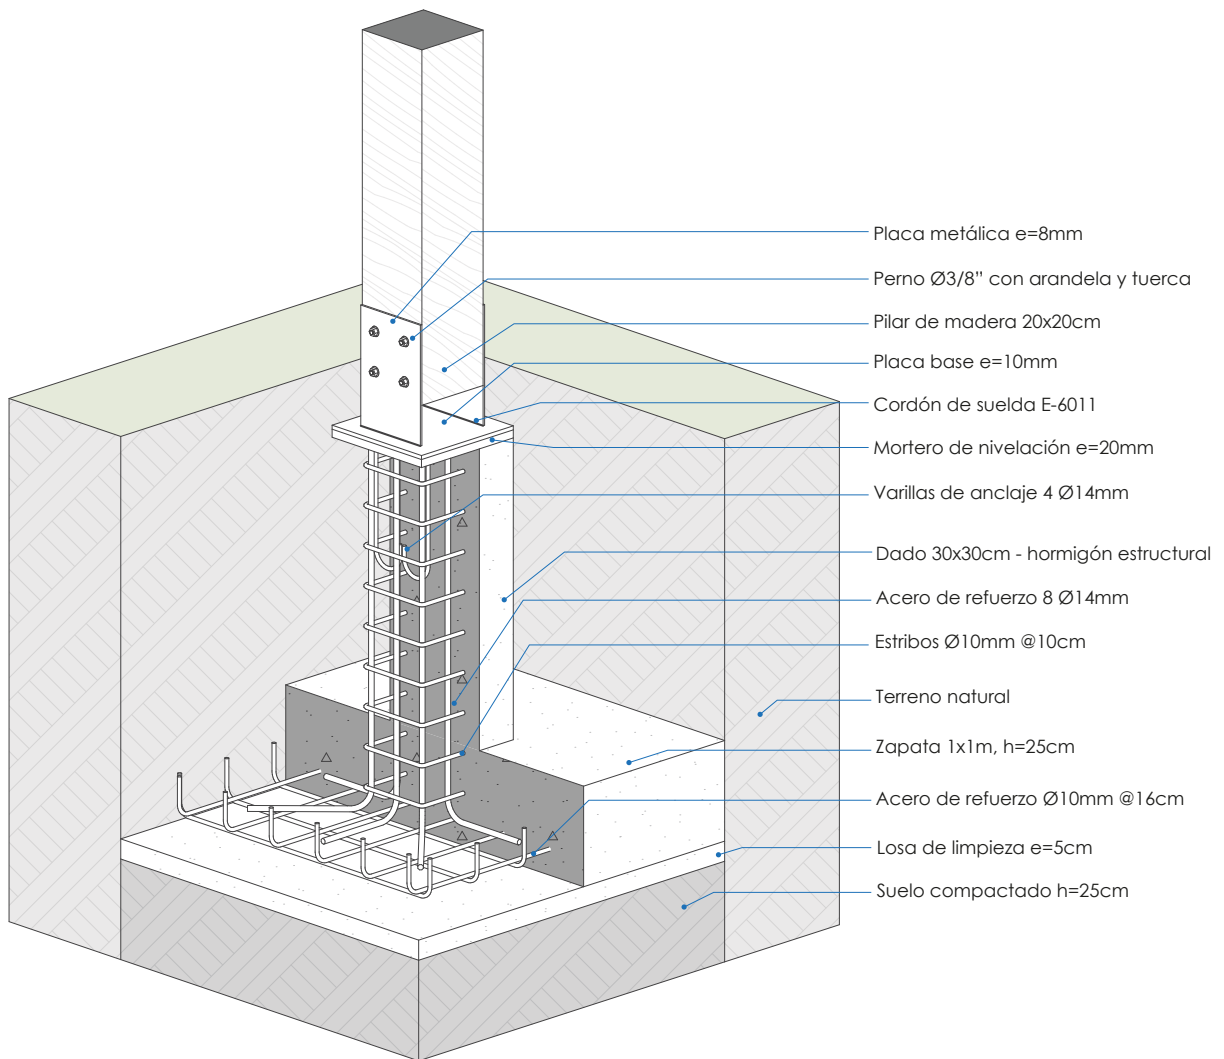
Detalle constructivo: Unión pilar - cimiento
